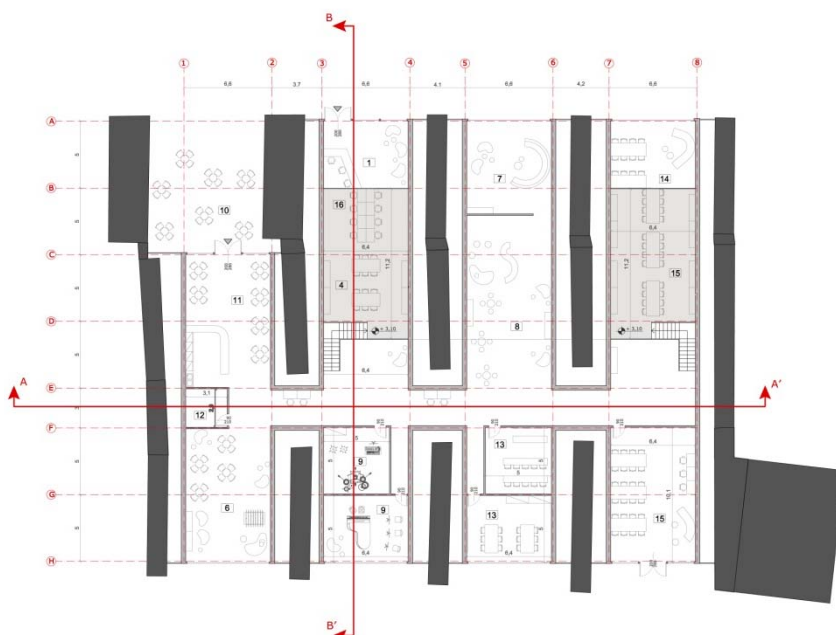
Pianta piano primo del centro ricreativo, stralcio della 5.06, *Pianta piano primo centro ricreativo*. Fonte: elaborazione grafica dell'autore
